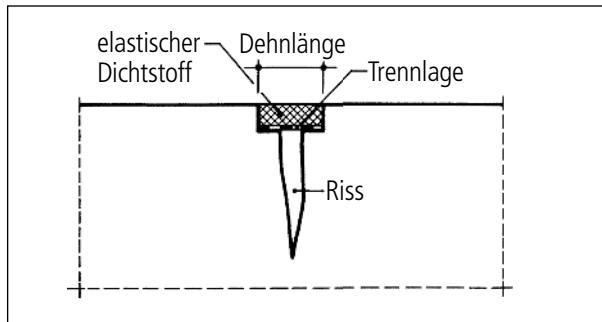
■ Schadensverlauf bei einer »Rissanierung« mit Dichtungsmasse
